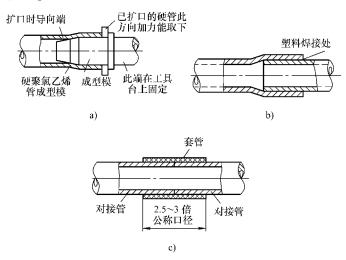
塑料管的连接 a) 胀管插接 b) 接口焊接 c) 套管连接
